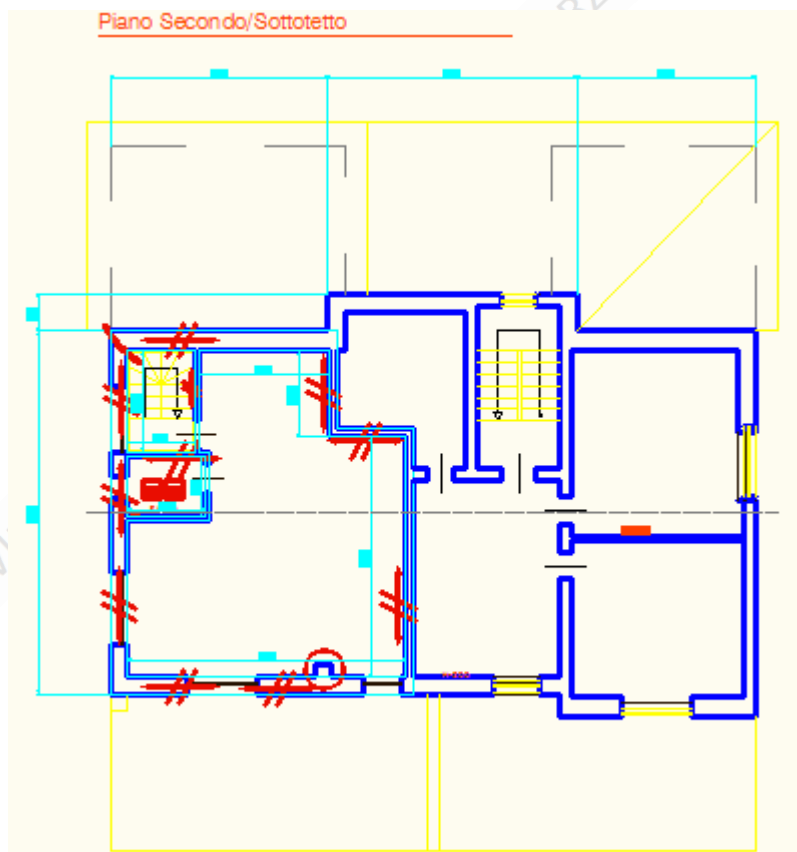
Planimetria del piano secondo in cui sono riportati i danni subiti dalla struttura.
